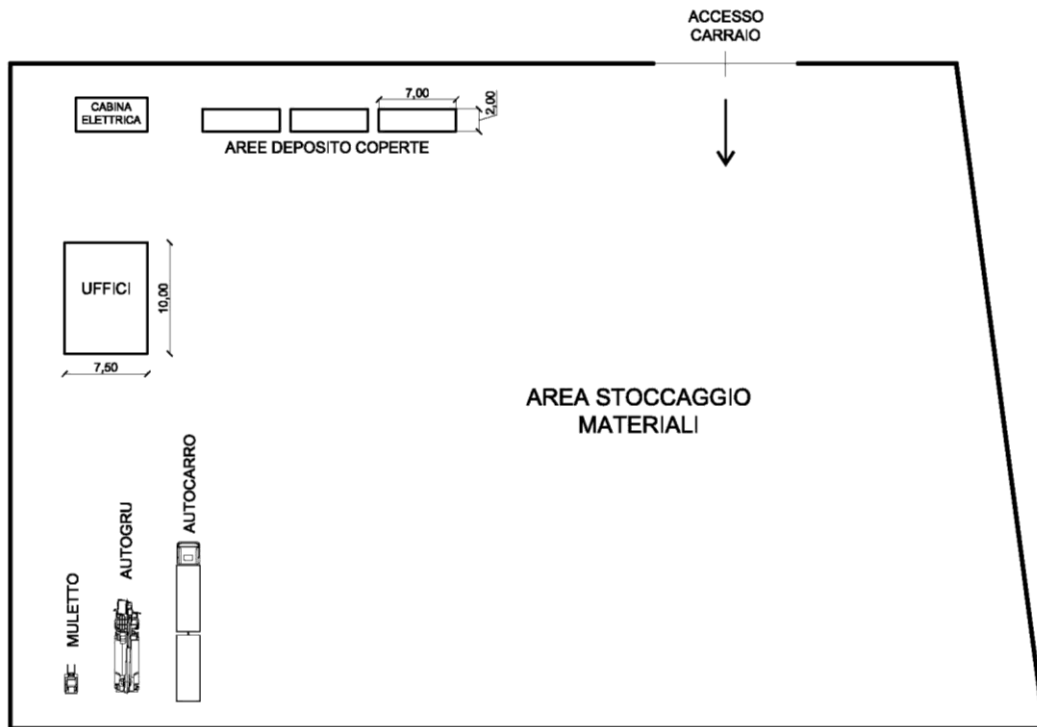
Planimetria dell'Area centrale – Tipologico
